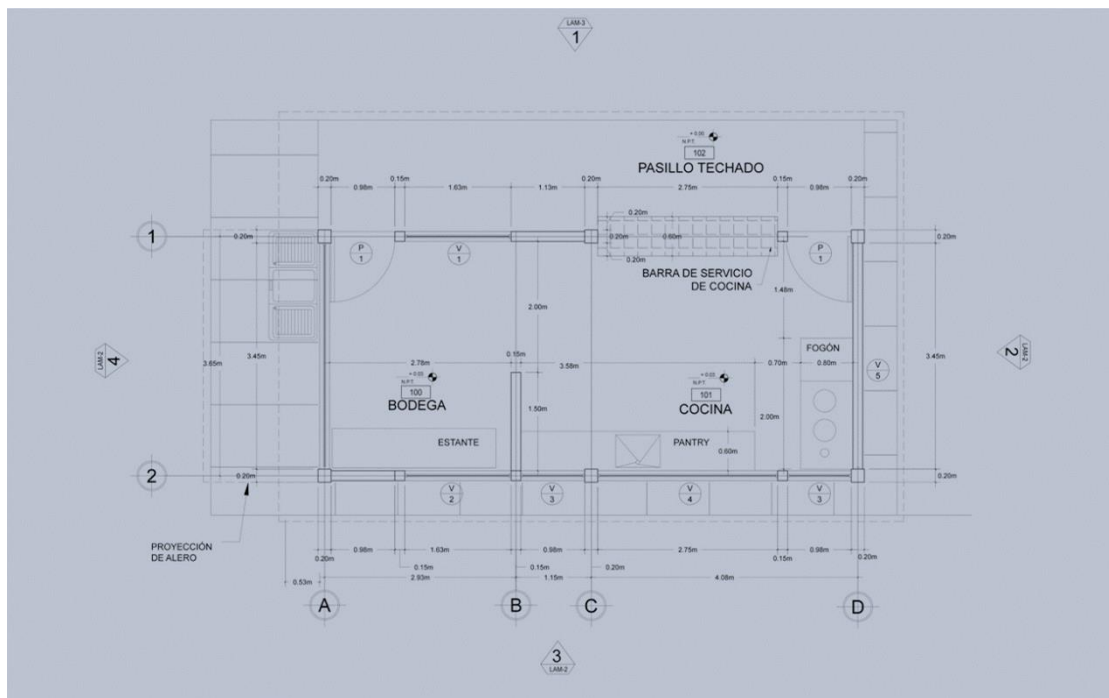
Planta Arquitectónica del Pabellón 5: Cocina Bodega, Fuente: Área de Preinversión MINED
